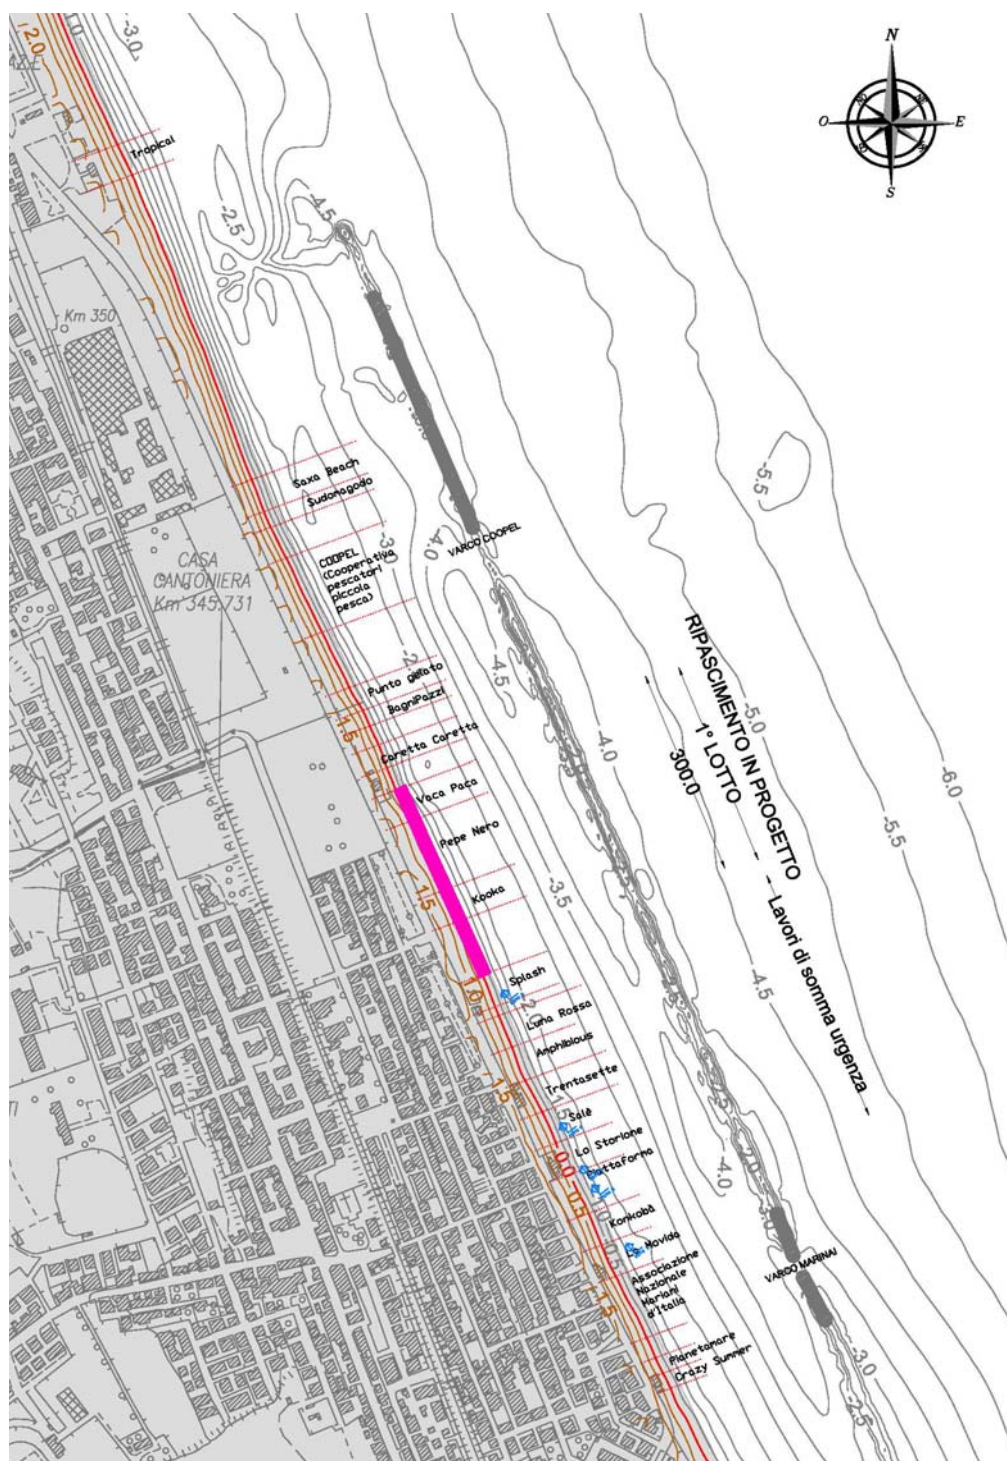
Stralcio Planimetria di Progetto Esecutivo – 1° Lotto
